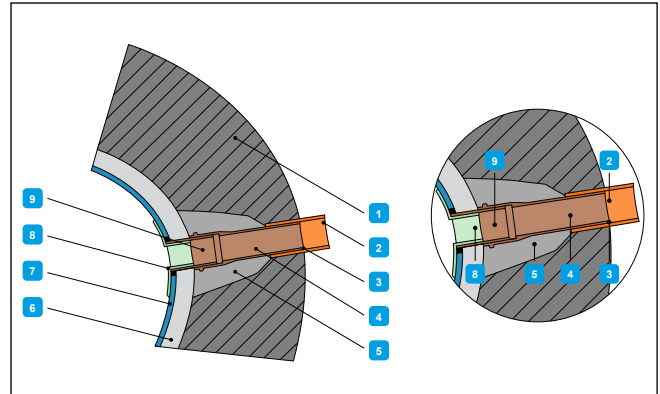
Principe de raccordement d'un branchement latéral en mauvais état structurel | Voir la légende 3
